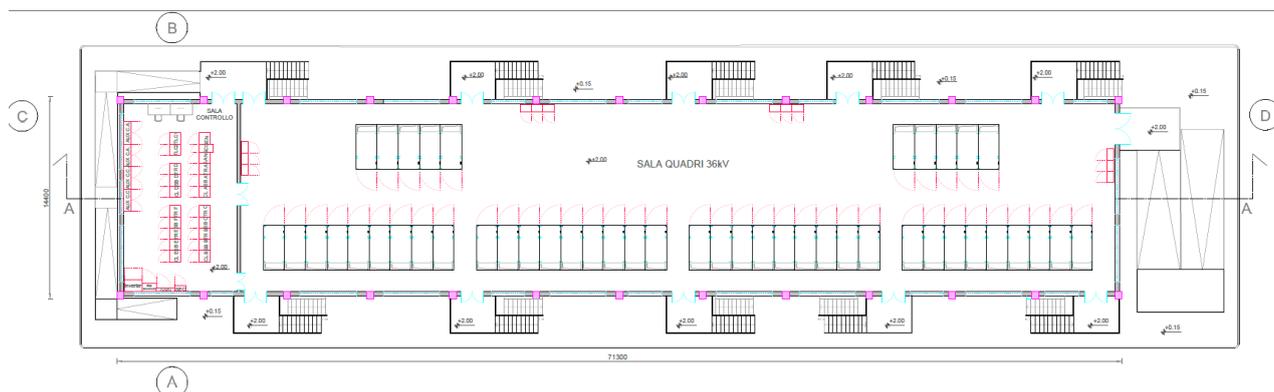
planimetria tipologica edificio quadri 36 kV
